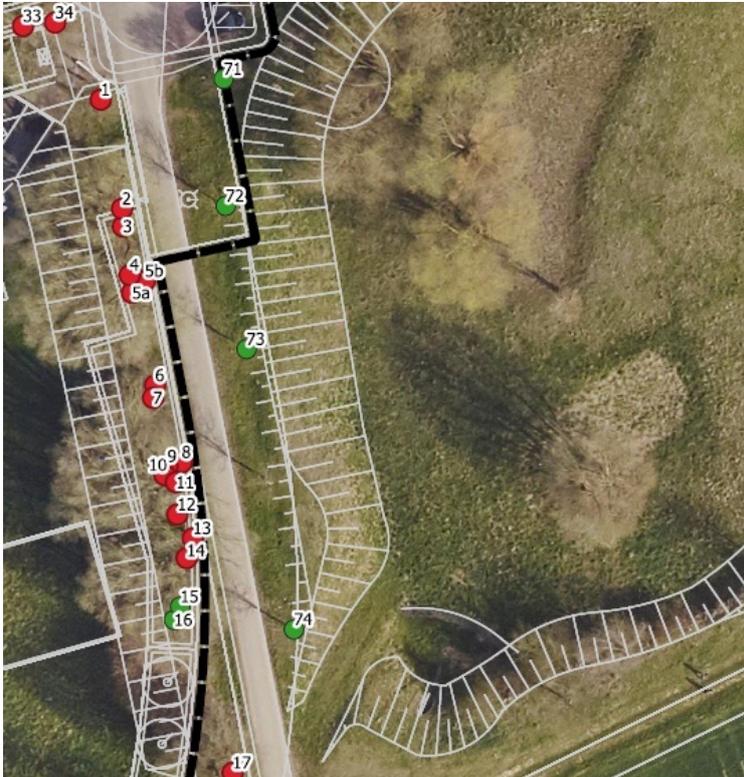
Ausschnitt Lageplan Nordosten
